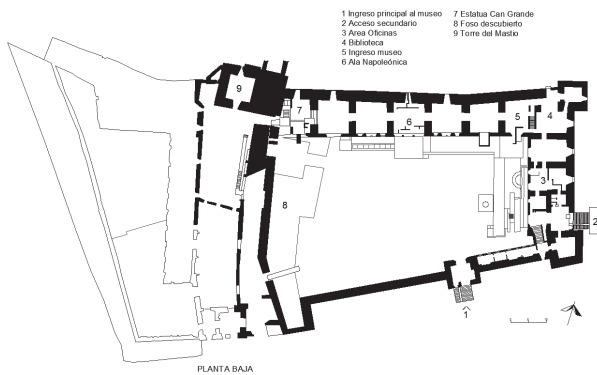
Plano de la planta baja de Castelvecchio, elaboración propia.
